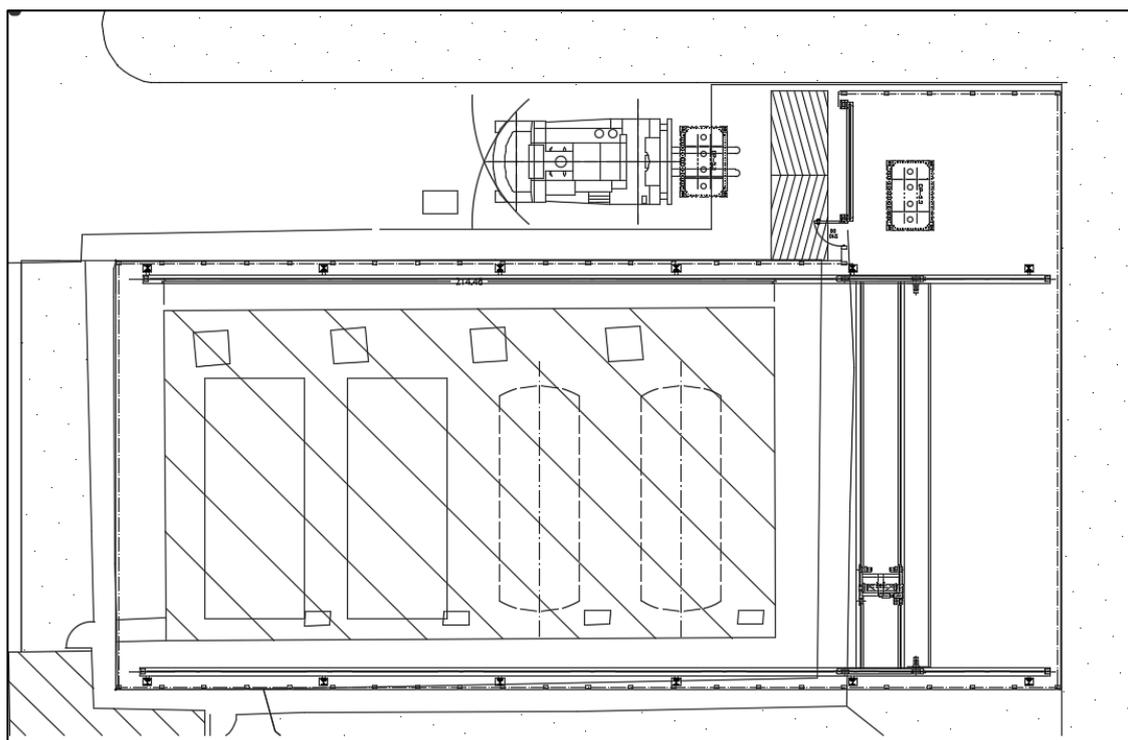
Facility di smantellamento edificio 21f – Pianta
